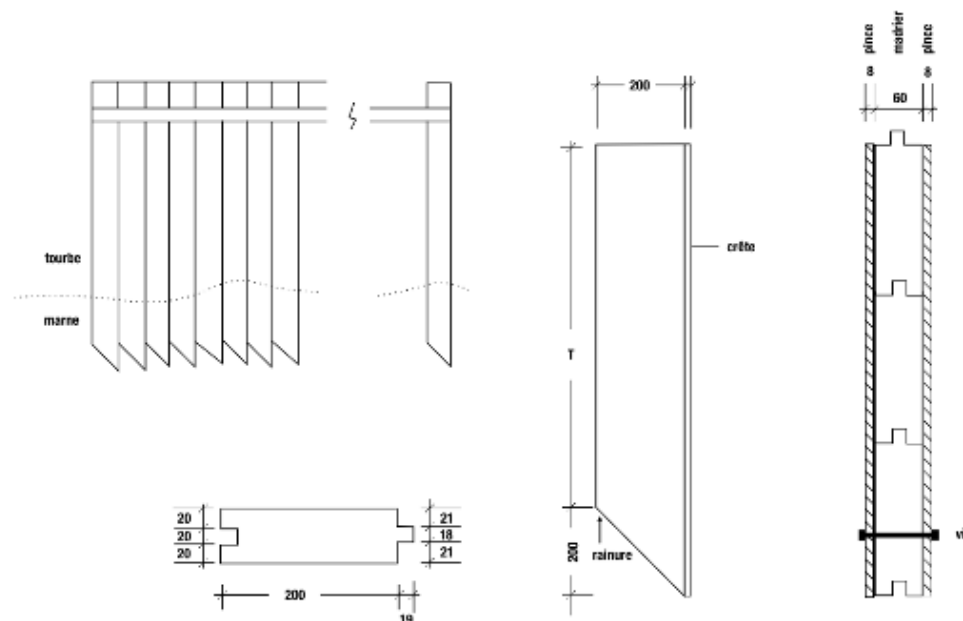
Exemple de plan de palissade en madriers rainurés / crantés de section 200x60 mm (Régénération des hauts-marais - OFEV 2009)
